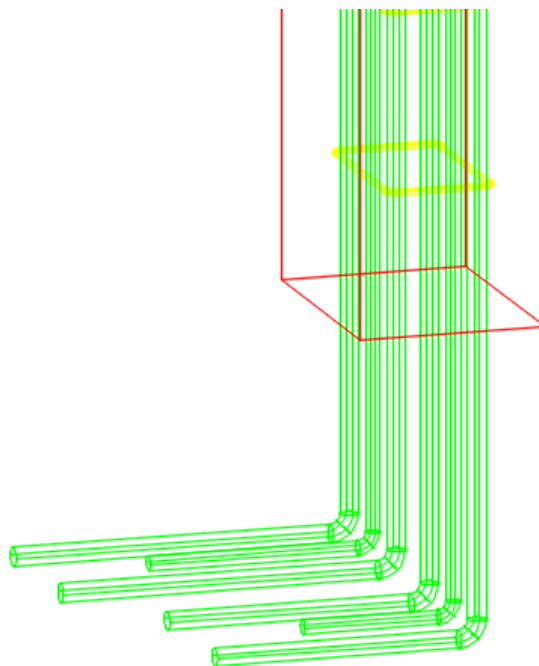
Pormenor 2 - barra (Fund. – Piso 1).
